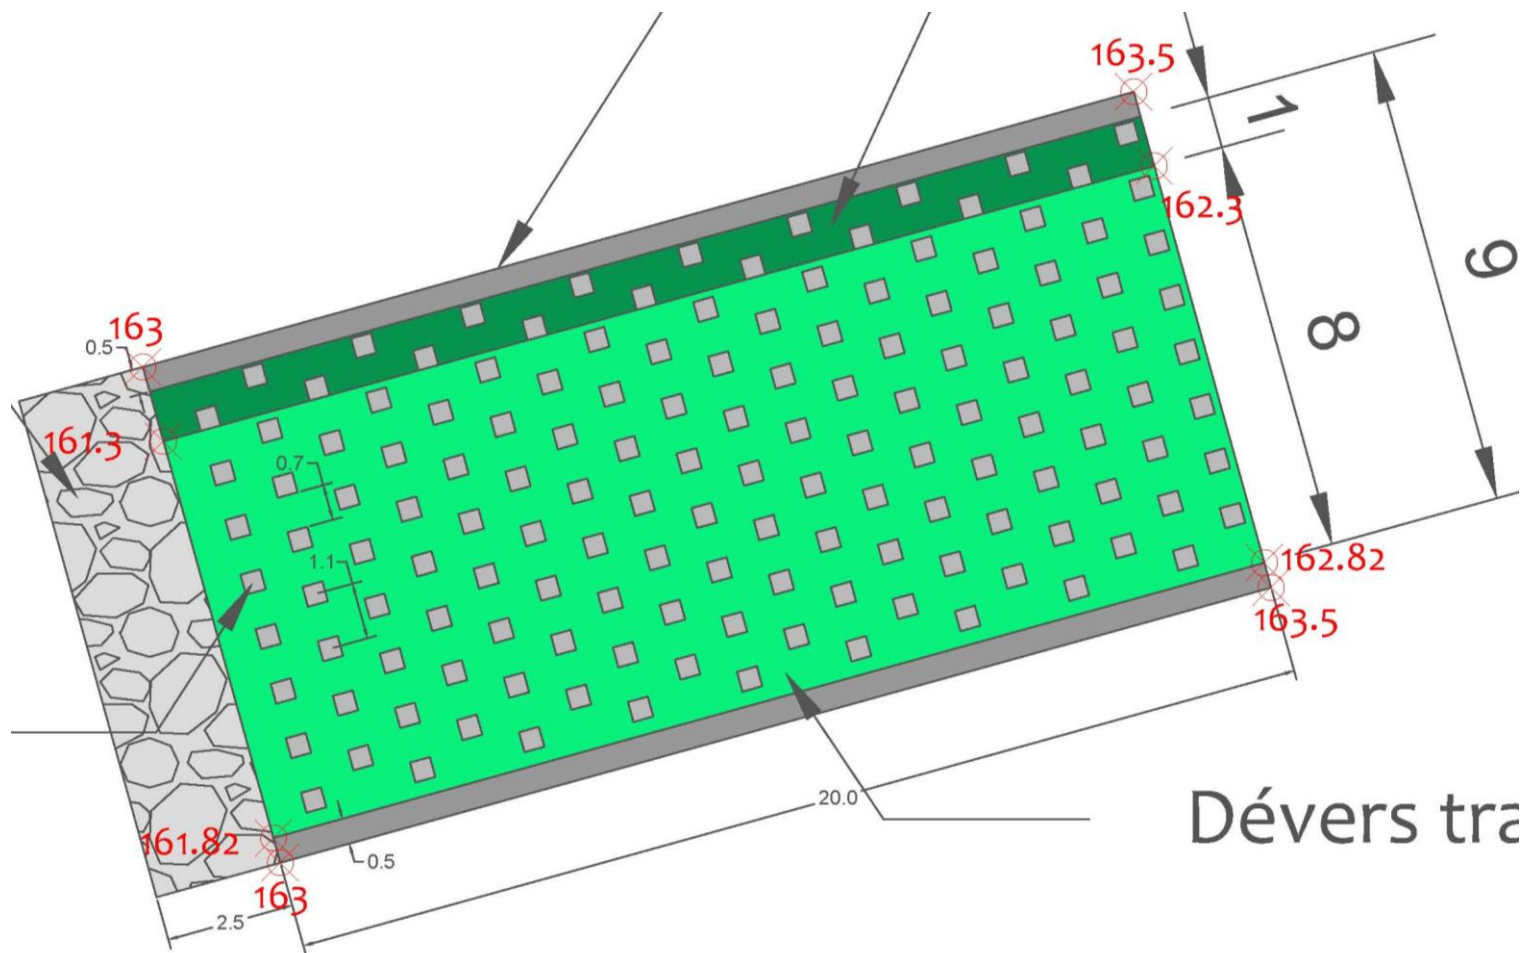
Extrait du plan de projet au droit du seuil de la RD20 – Zoom sur la rampe
